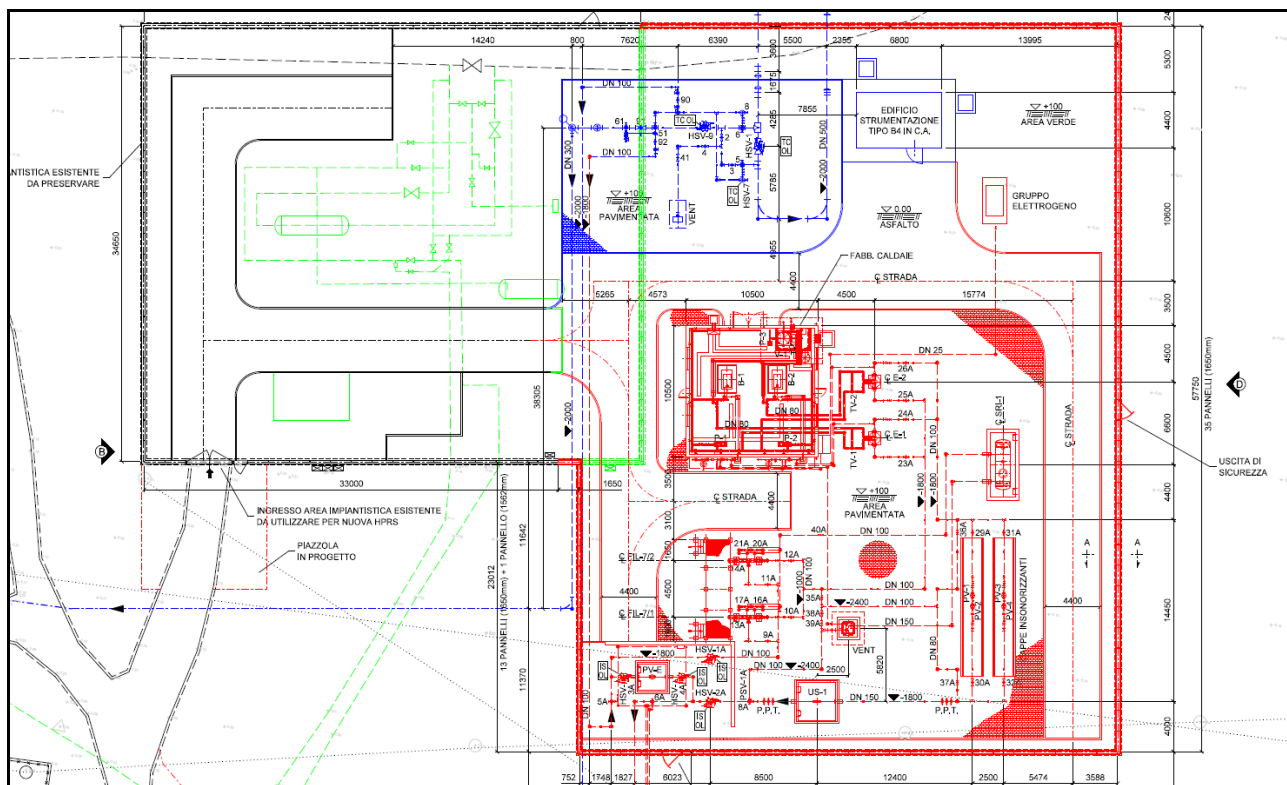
Elaborato planimetrico non in scala con individuazione del nuovo impianto in progetto
